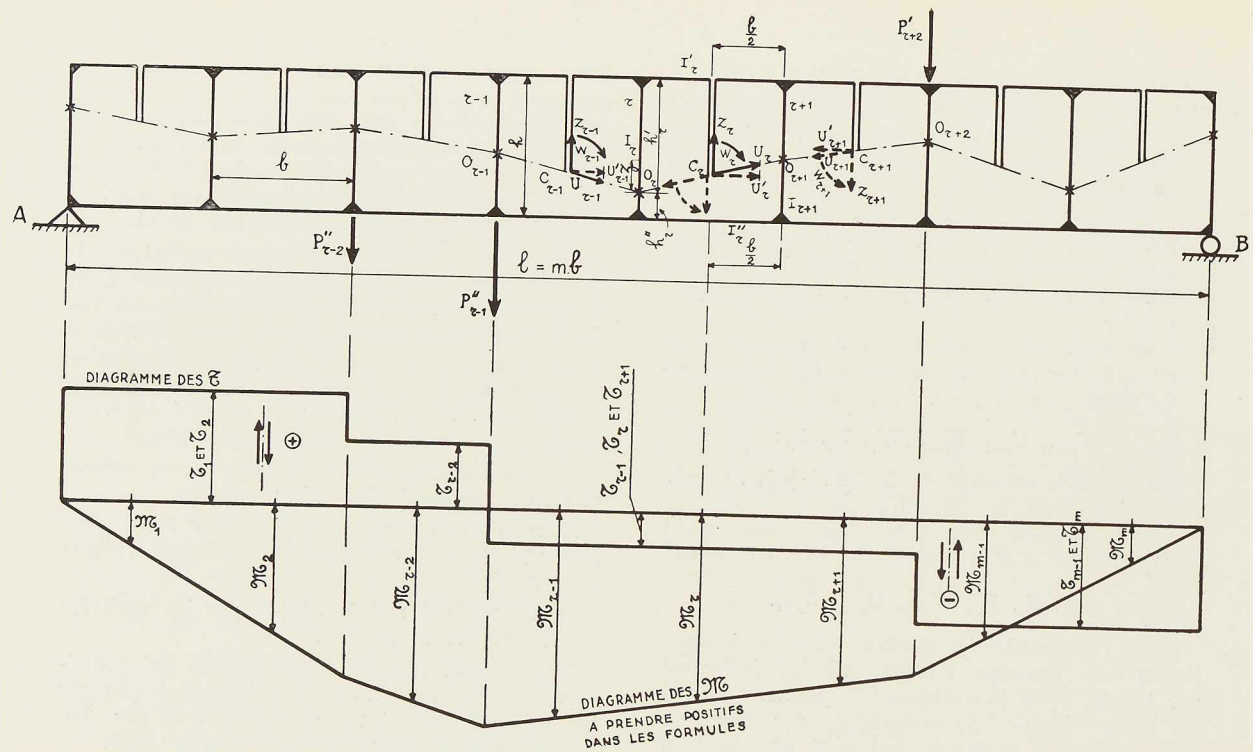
Le schéma d'une poutre de hauteur constante avec des diagrammes M et S .
